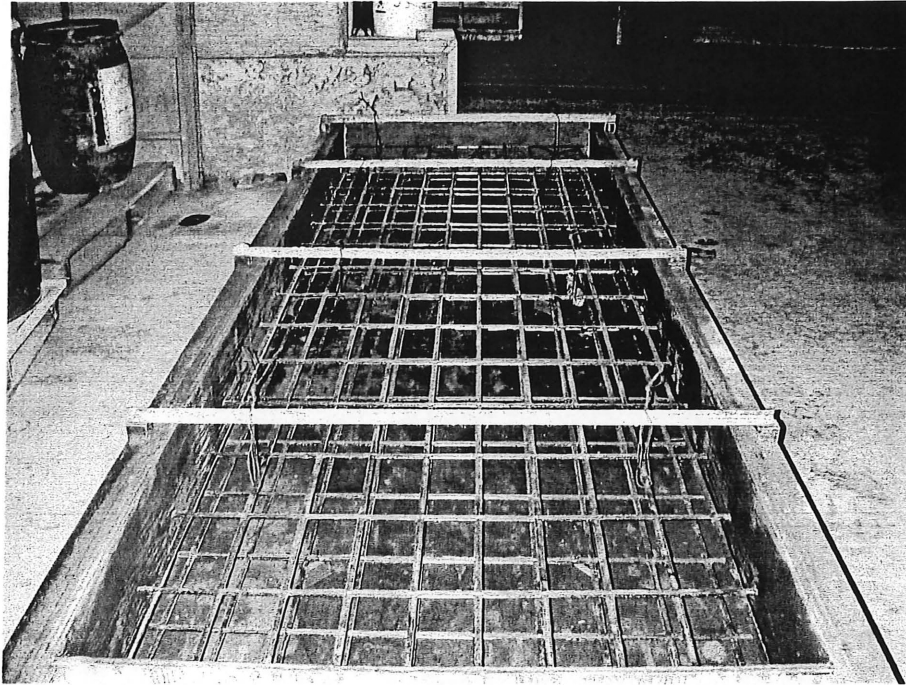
Coffrage de la dalle renforcée en NEFMAC
